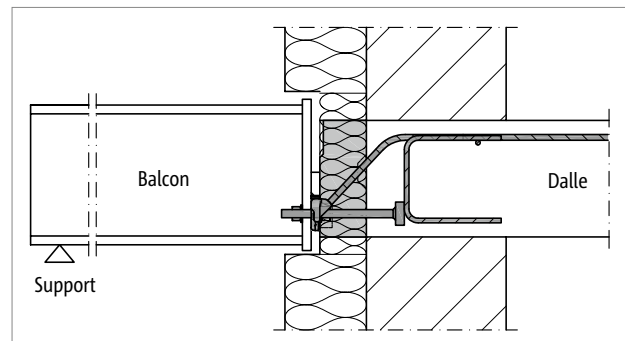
Schöck Isokorb® T type SQ : Raccordement à la dalle en béton ; corps isolant à l'intérieur de l'isolation externe
